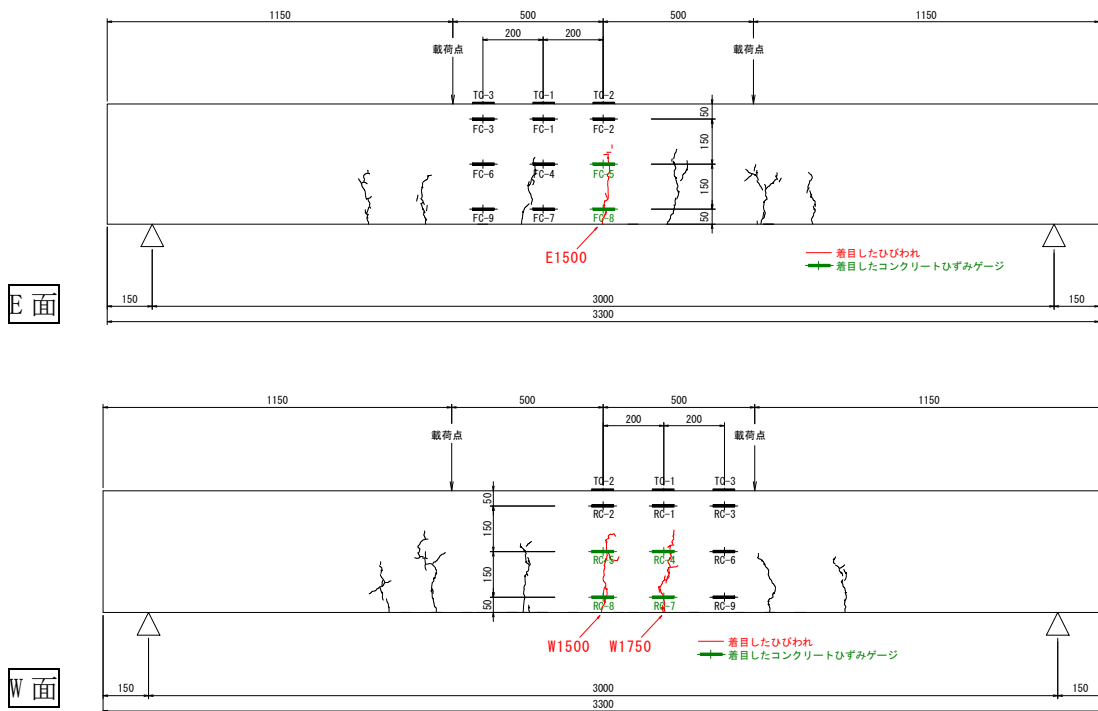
着目したひび割れとひずみゲージ位置 (RC46-900)
